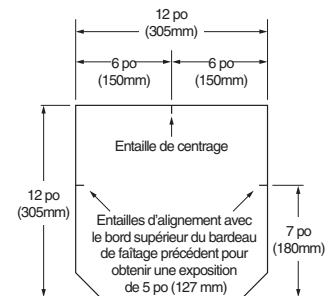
Chaque bardeau Shadow Ridge comporte une entaille de centrage et deux entailles d'alignement latéral qui facilitent leur mise en place.
